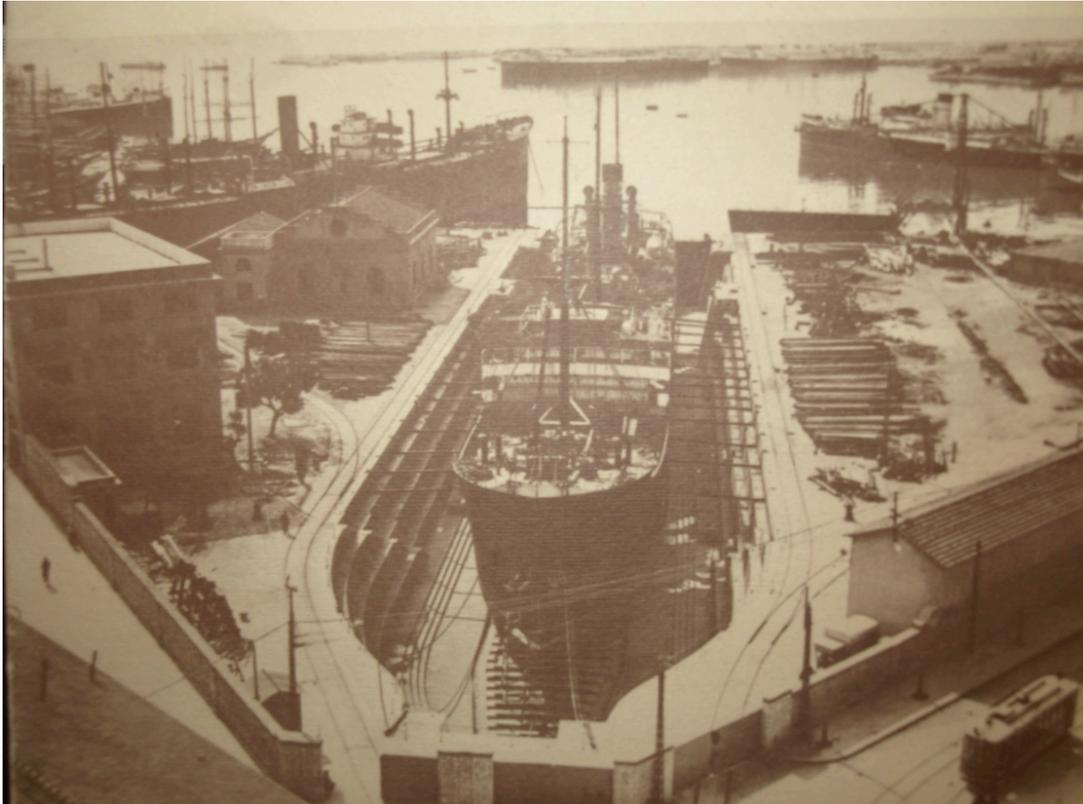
In basso, vista parziale dei margini del cantiere a ridosso del bacino e della linea tramway che, attraverso la via Molo congiungeva la città alla borgata dell'Acquasanta
